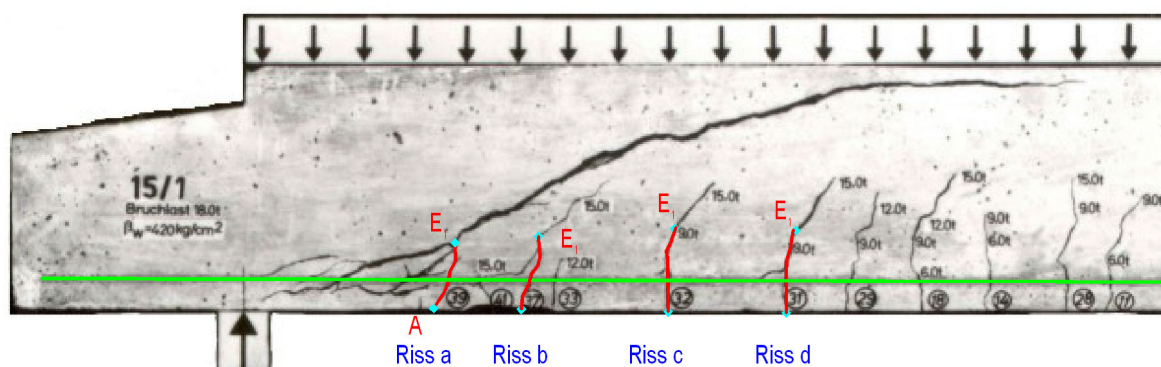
Ausschnittsvergrößerung des Balkens 15/1 aus [2.4] mit Kennzeichnung der Rissabschnitte A - E_1 im Zustand II.1
